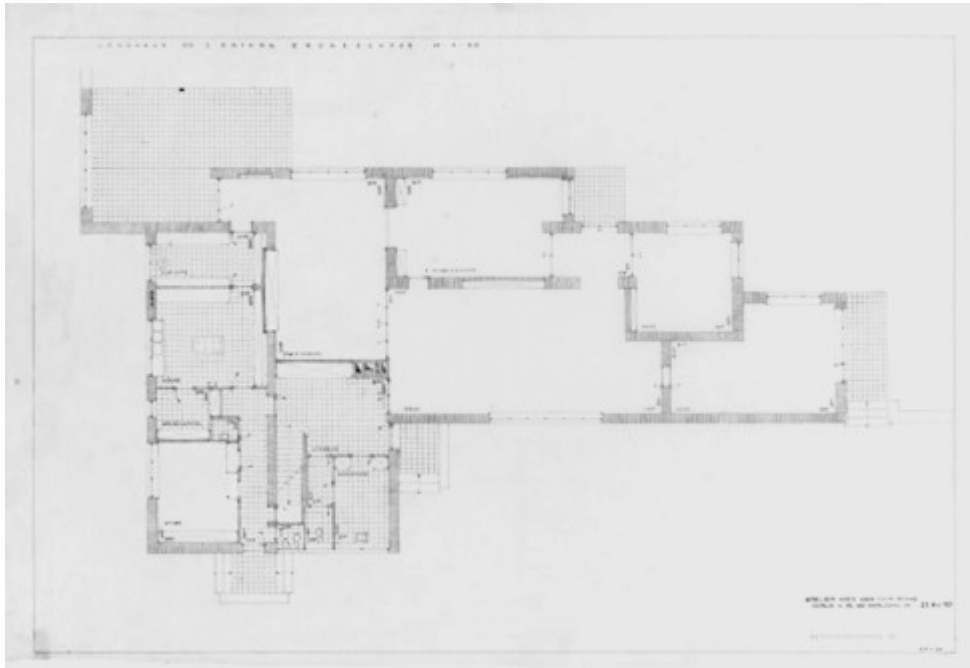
Planta baixa pavimento térreo, Casa Esters, 1927
